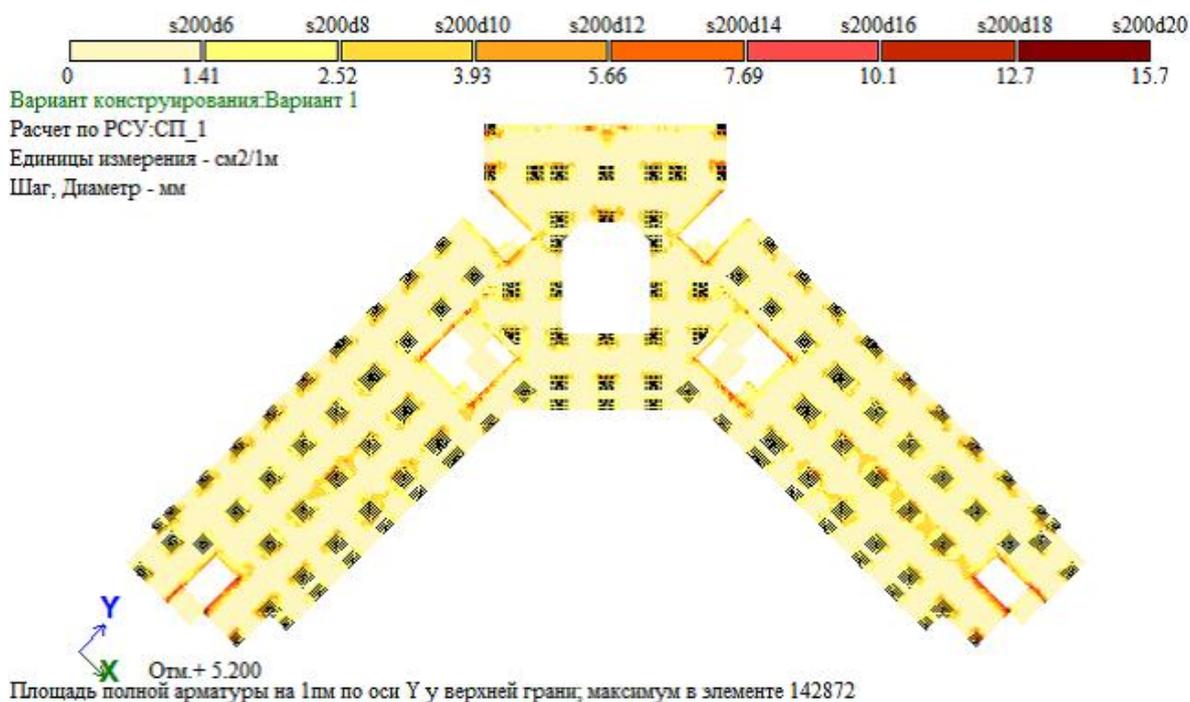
Армирование плиты на отм. +5.400. AS4 (верхняя по Y1)
